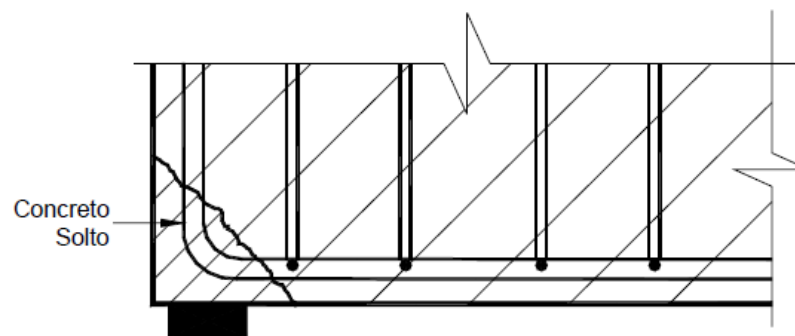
Fissuras por Corrosão de Armadura
